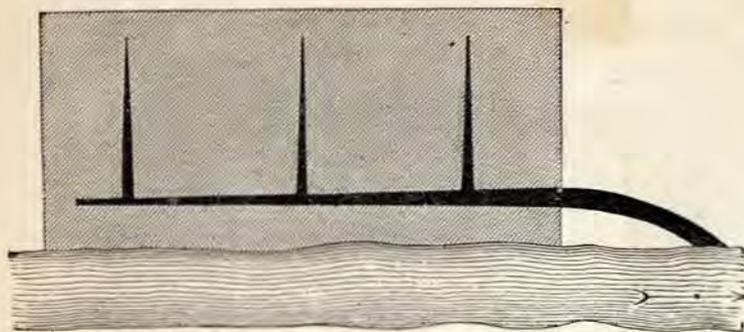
Figura schematica indicante l'ampiezza di sezione necessaria per l'insieme dei canali, secondo il sistema di canalizzazione inglese.
